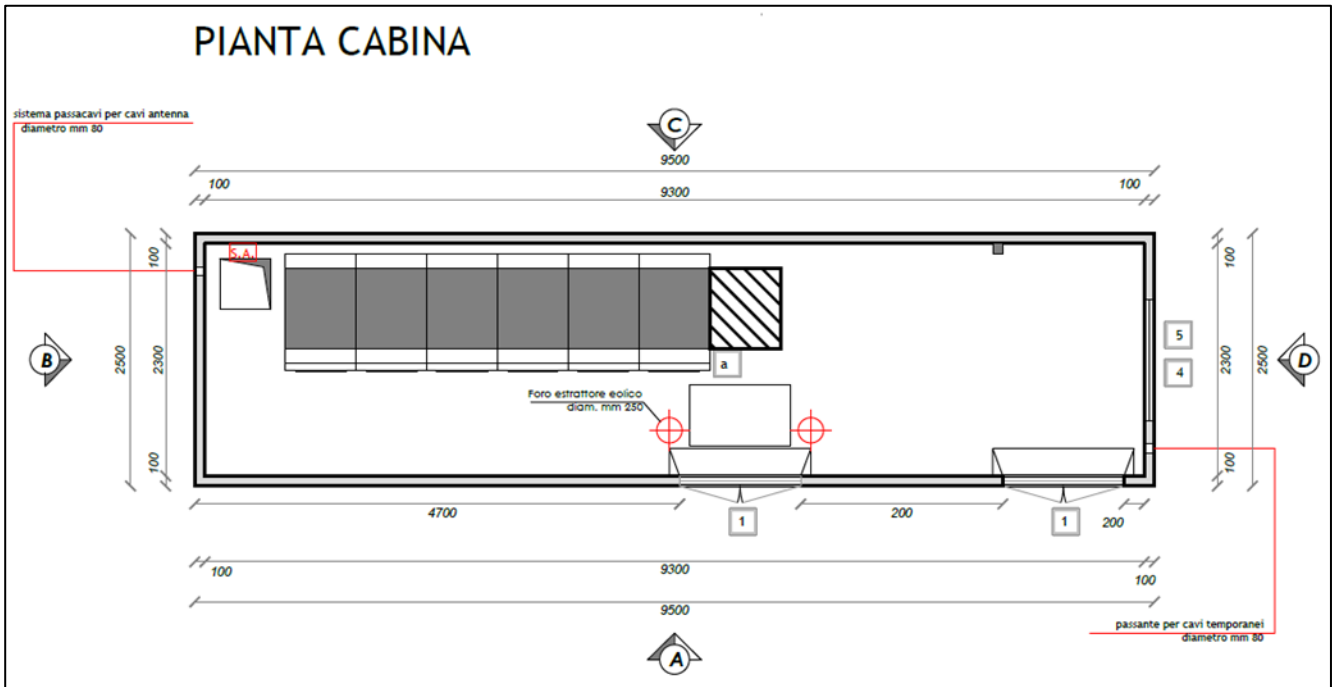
Planimetria cabina di raccolta – vista dall’alto
